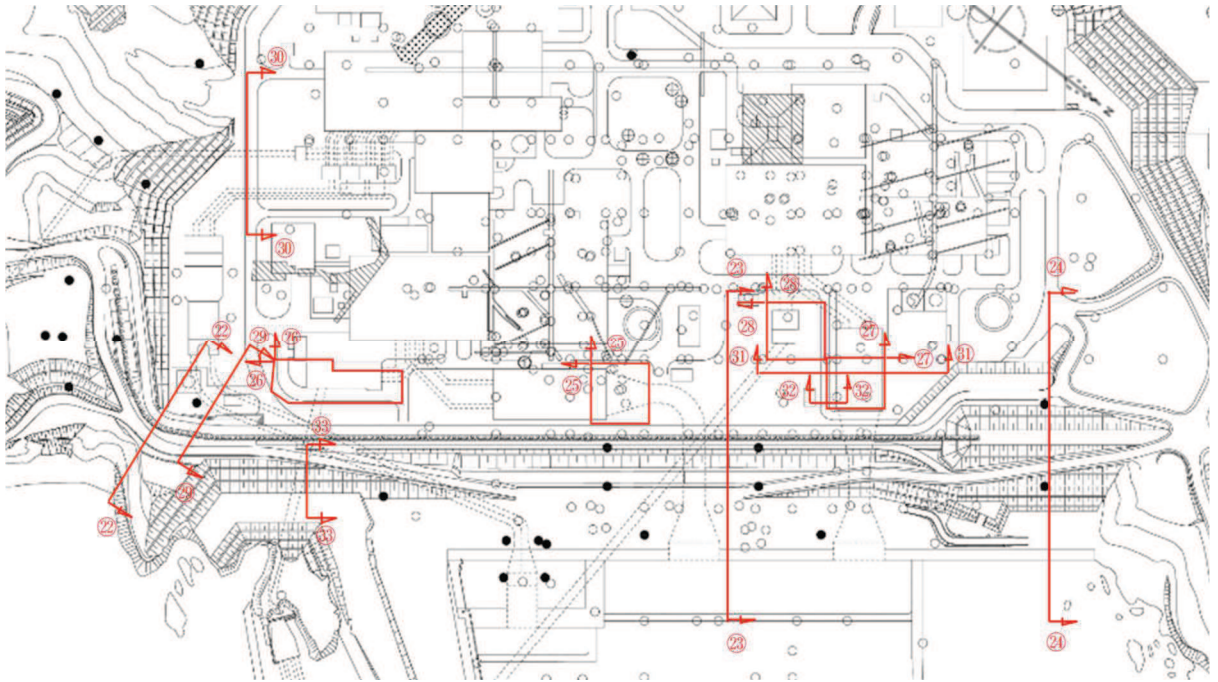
(3) 地質断面図位置 (22-22断面~33-33断面)
